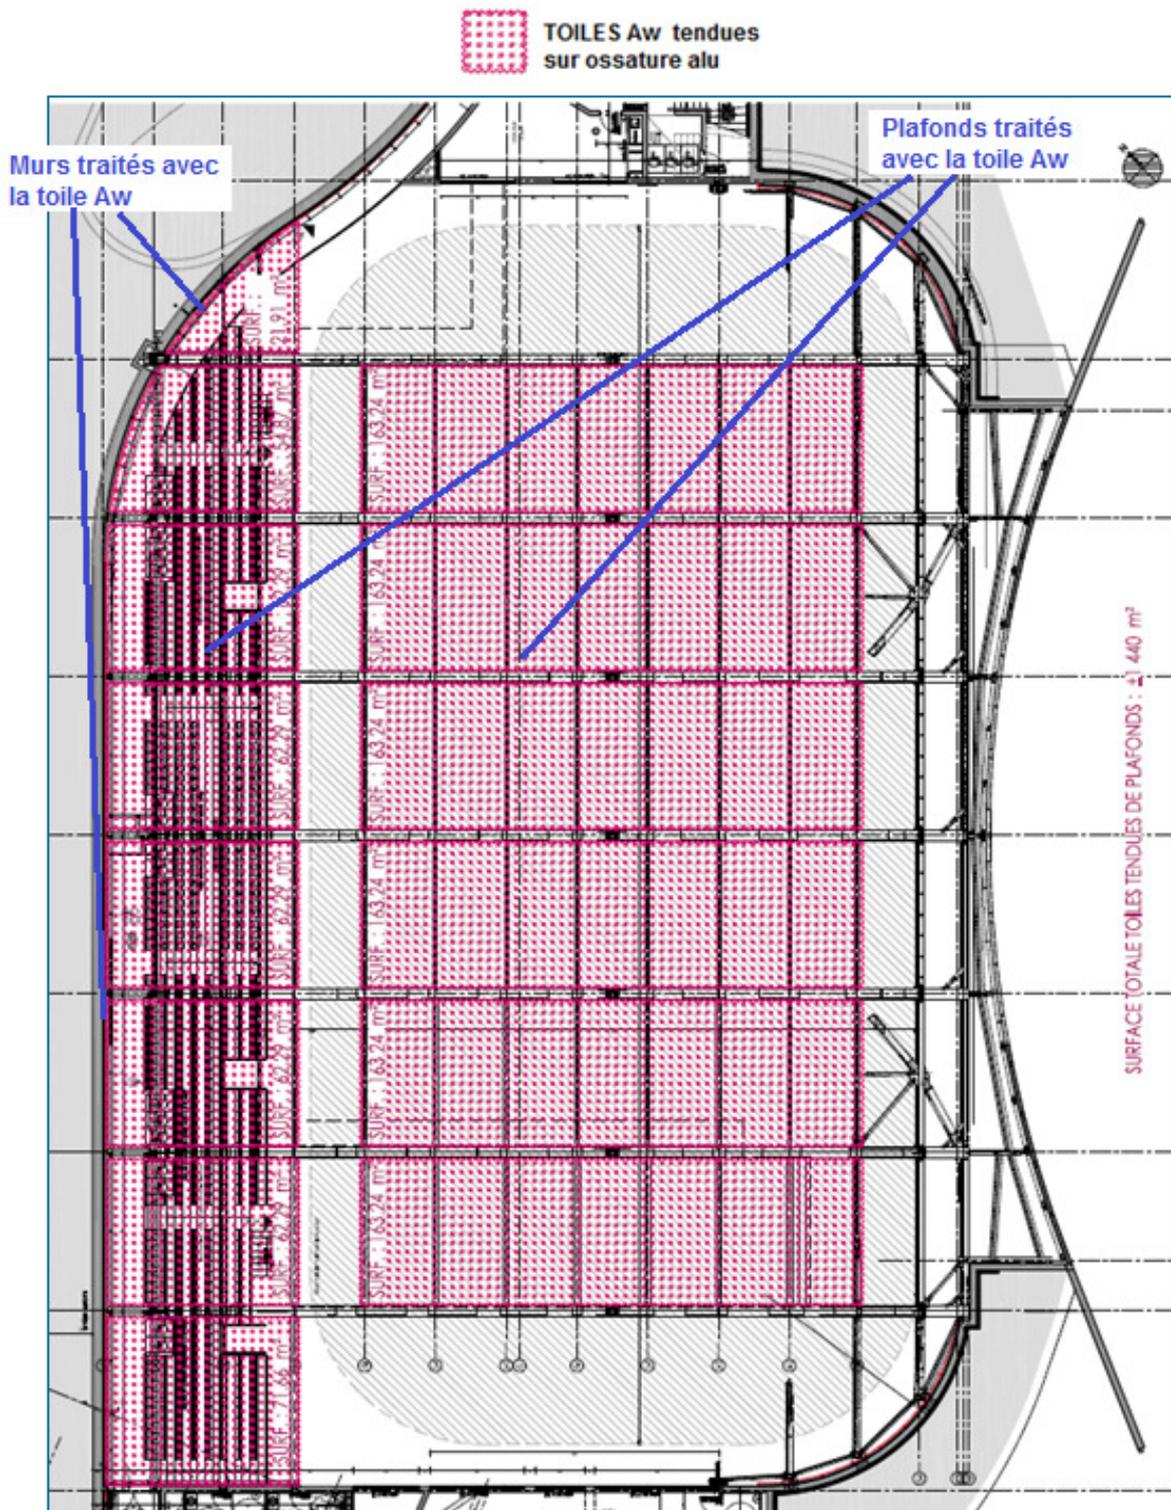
Plan montrant les surfaces des murs et du plafond de la patinoire de Vaujany traitées avec la toile BATYLINE Aw.
